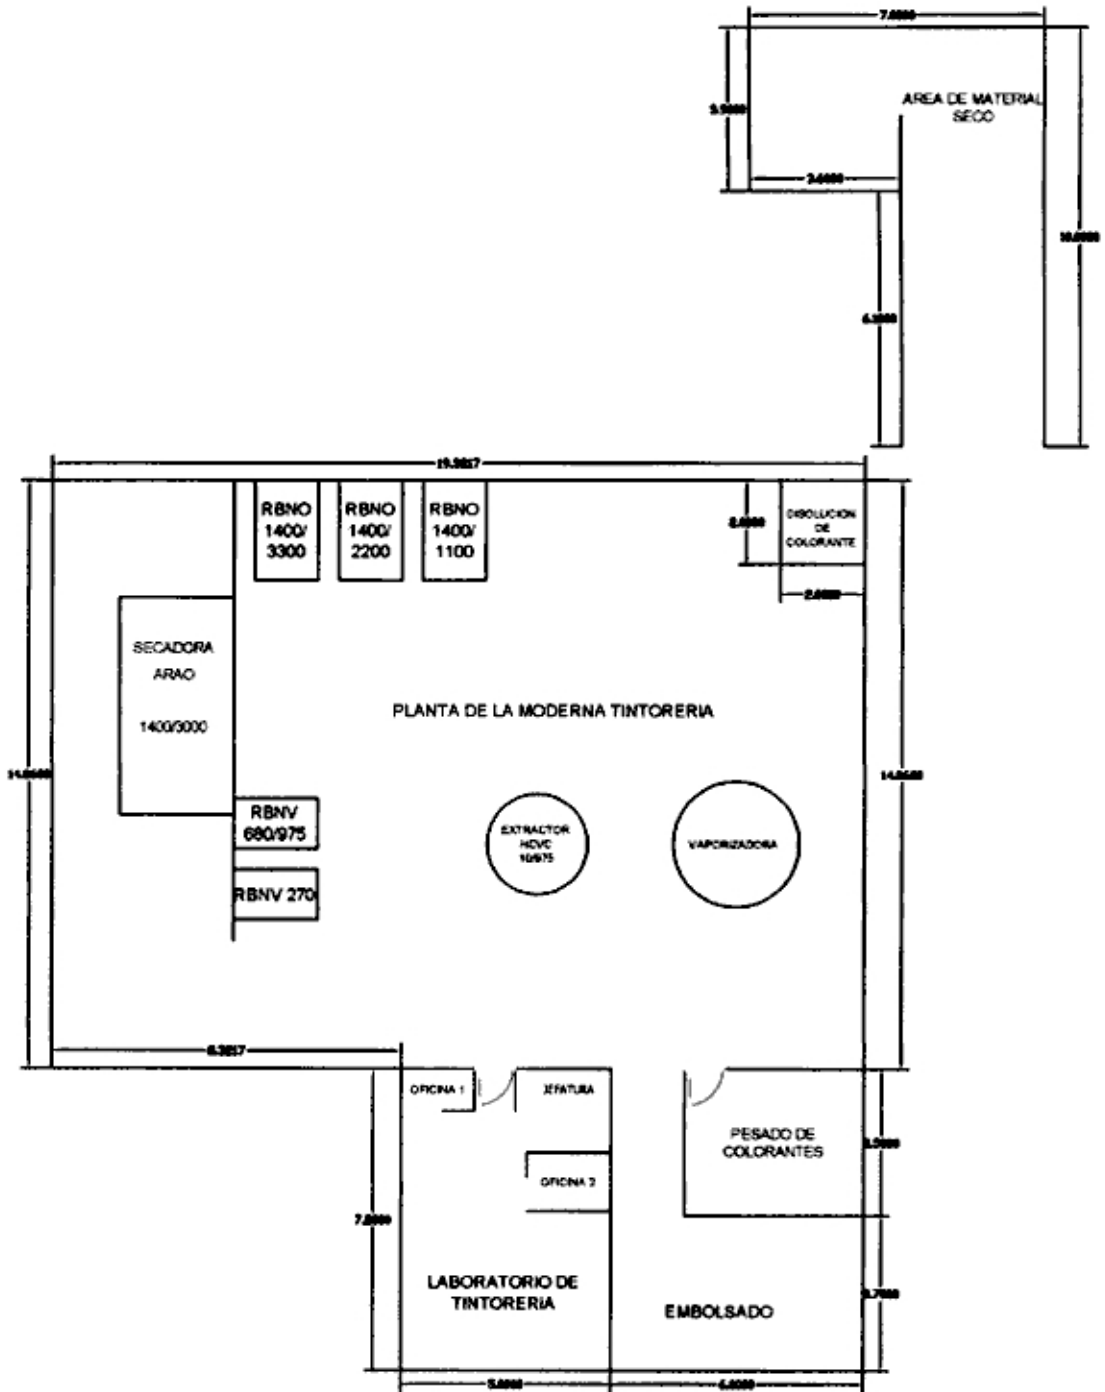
DISTRIBUCION DE PLANTA MODERNA
